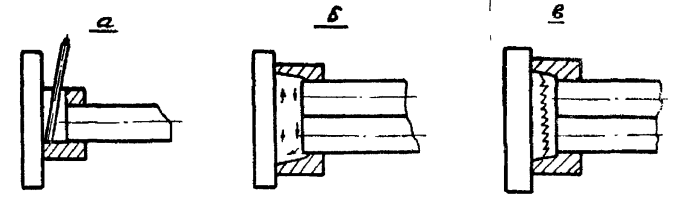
Техника многослойной сварки в медной форме тавровых соединений спаренных стержней с пластиной.
